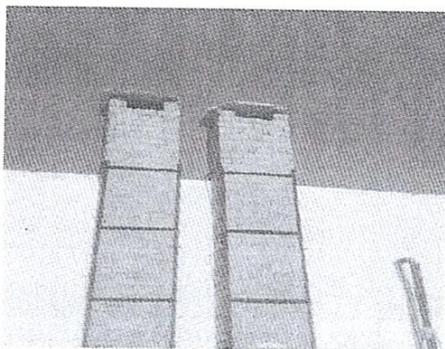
La construction des cheminées. Photo II.14: La décoration (âge, mob, G).
